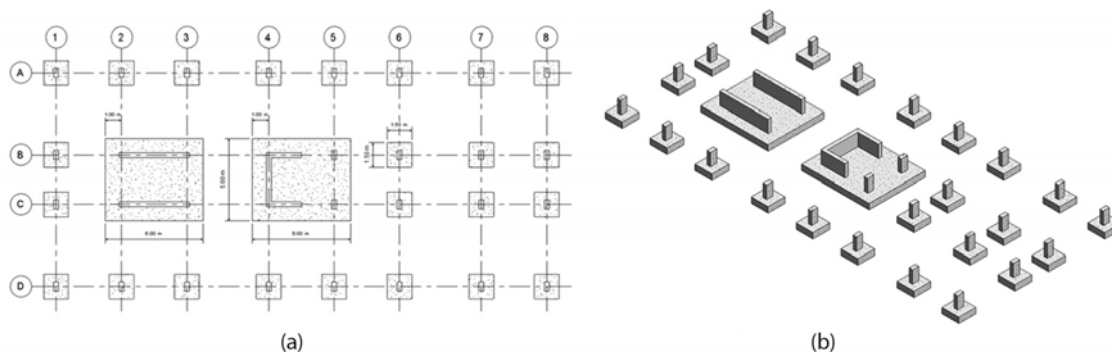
Distribuição de sapatas: (a) planta de fundações e (b) vista tridimensional
